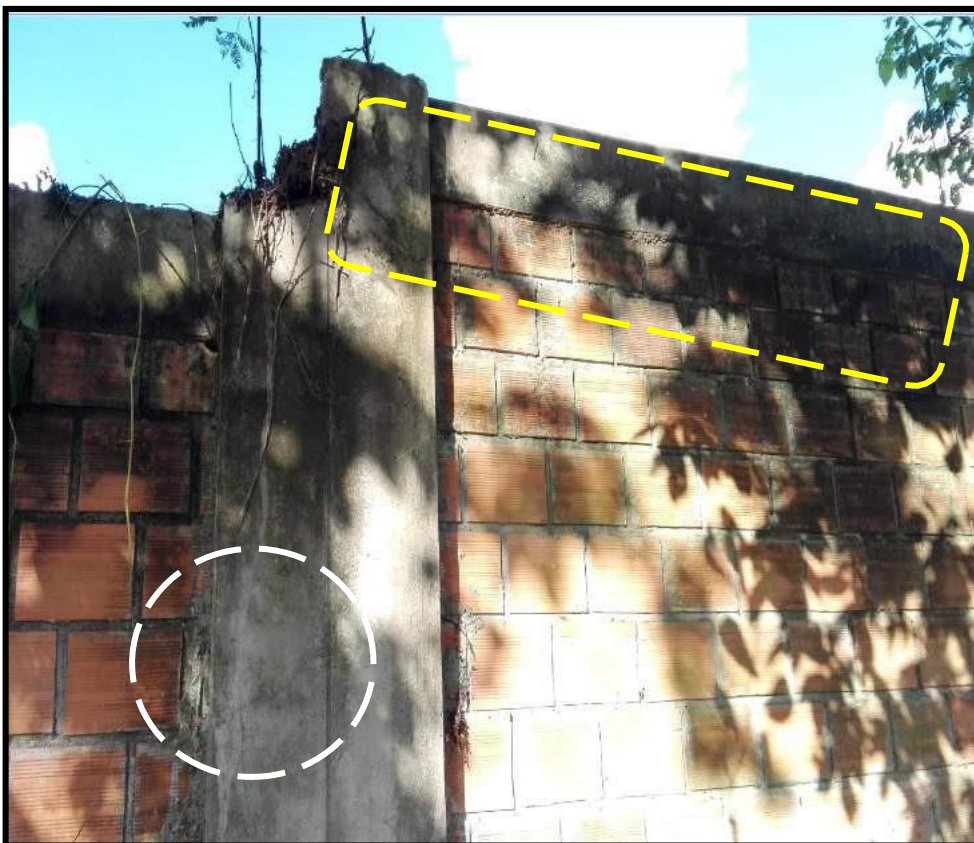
Presencia de fisuras longitudinales y eflorescencia.
